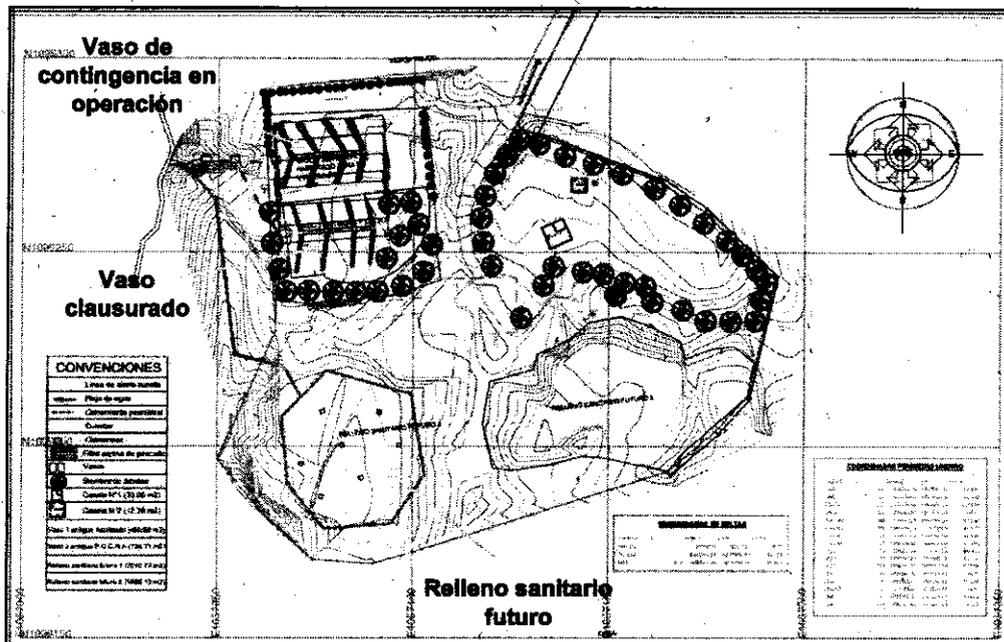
Plano en planta del SDF "La Mina" y proyección relleno sanitario futuro.
